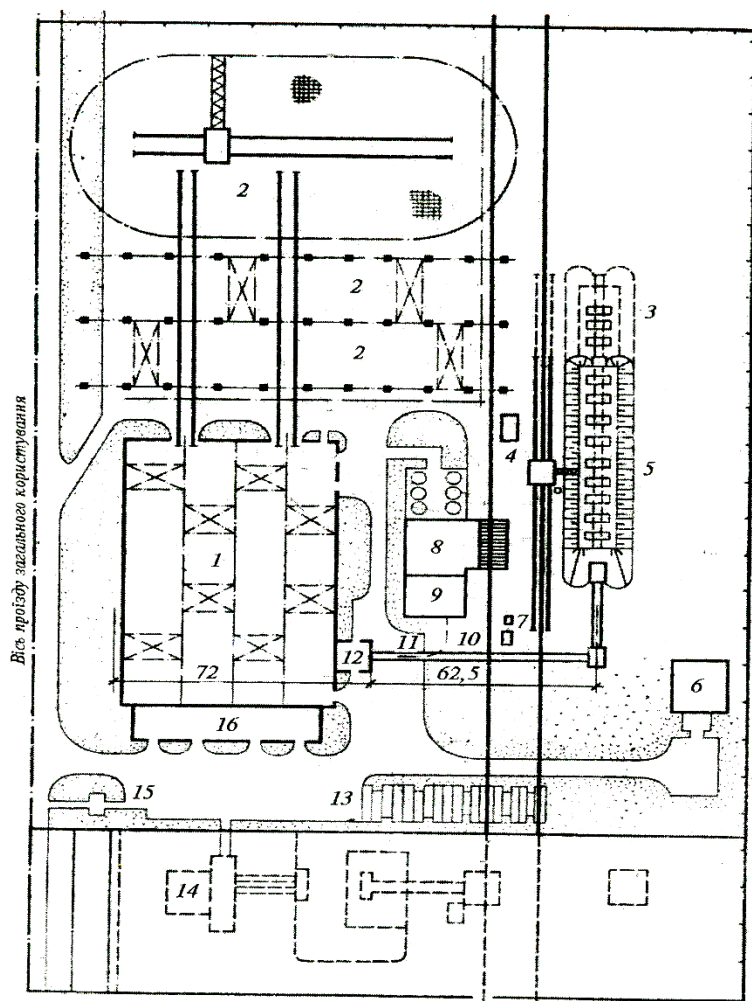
Генплан заводу залізобетонних конструкцій для промислового будівництва продуктивністю 70 тис. м³ на рік:
